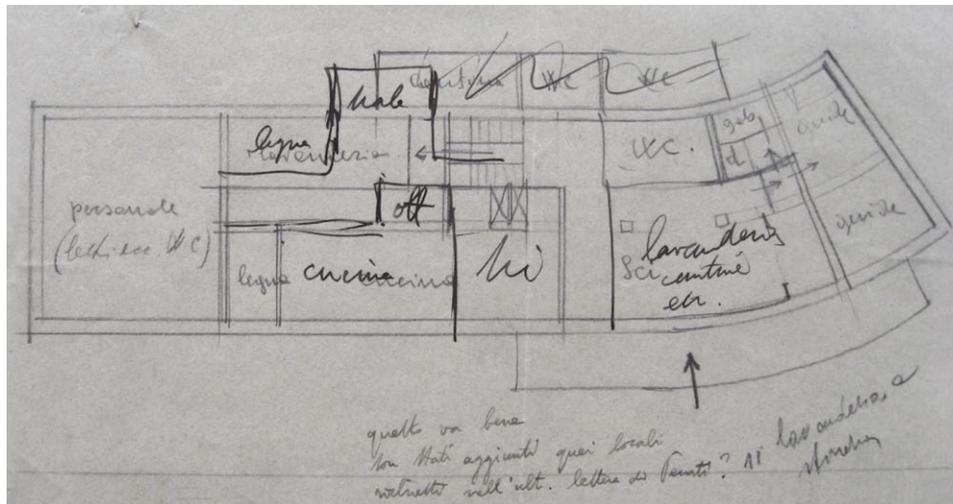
Grundriss EG: der vorspringende Saniterbereich wird durchgestrichen; die Treppe wird nach auen verlagert
